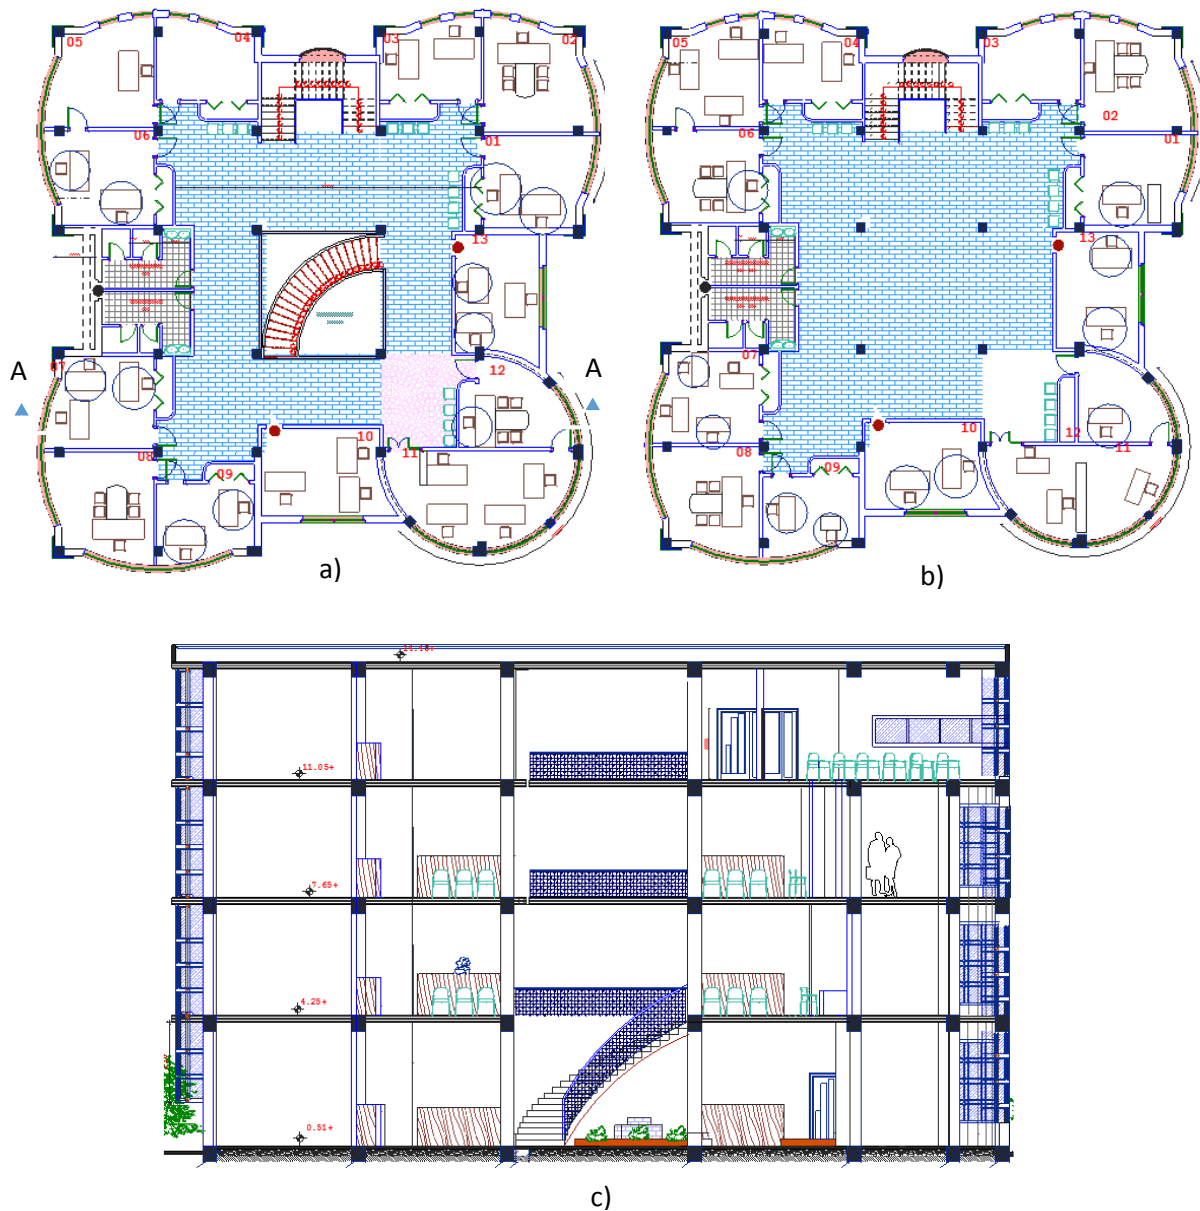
Bâtiment de la DTP, (a) plan du 1^{er} étage , (b) plan du 2^{em} étage ,(c) coupe AA(Source : Charrad,2012)
